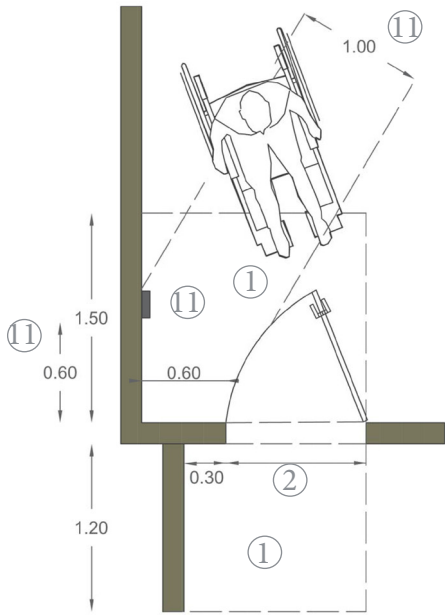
2 Dispositivo de accionamiento - Planta
